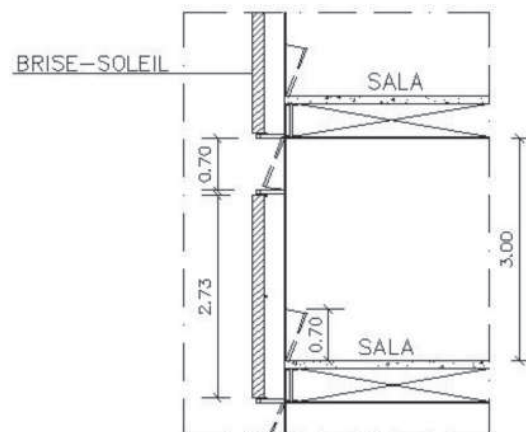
Corte AA do 3º ao 10º pavimento.⁷
